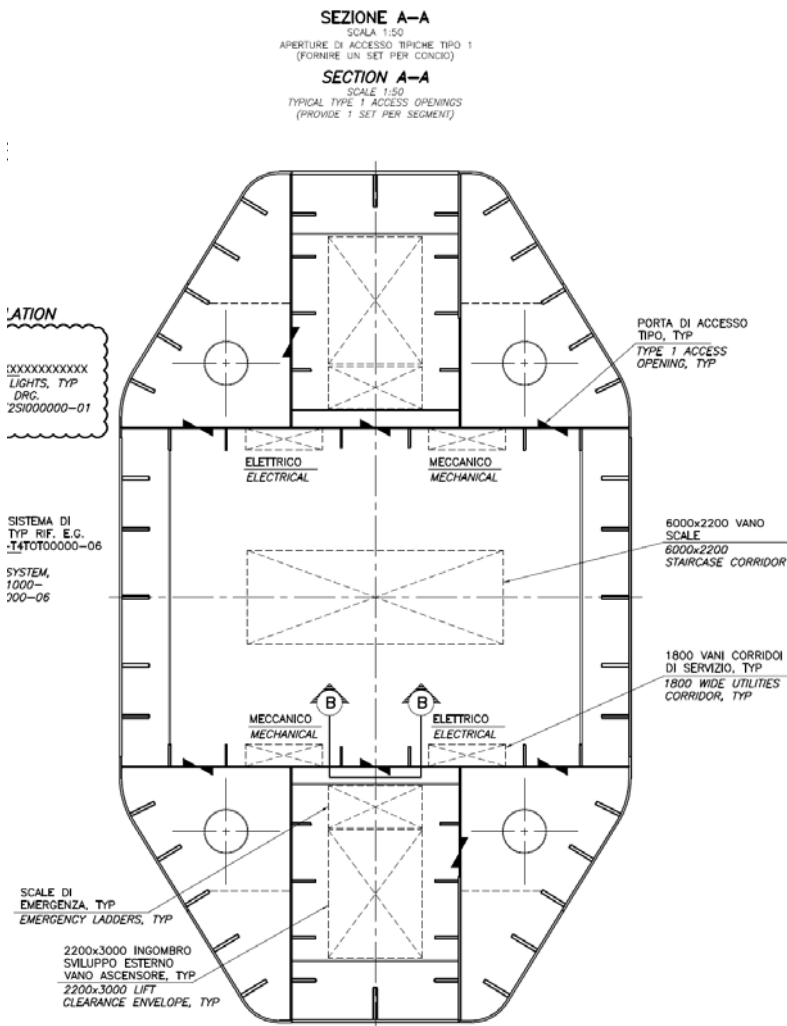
Tipiche aperture di accesso nella sezione trasversale della gamba della torre.
